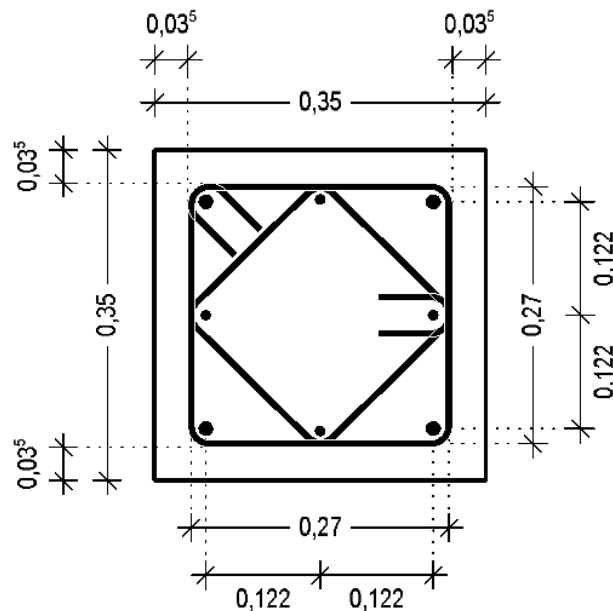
Dimensões e pormenorização do pilar exemplo.
